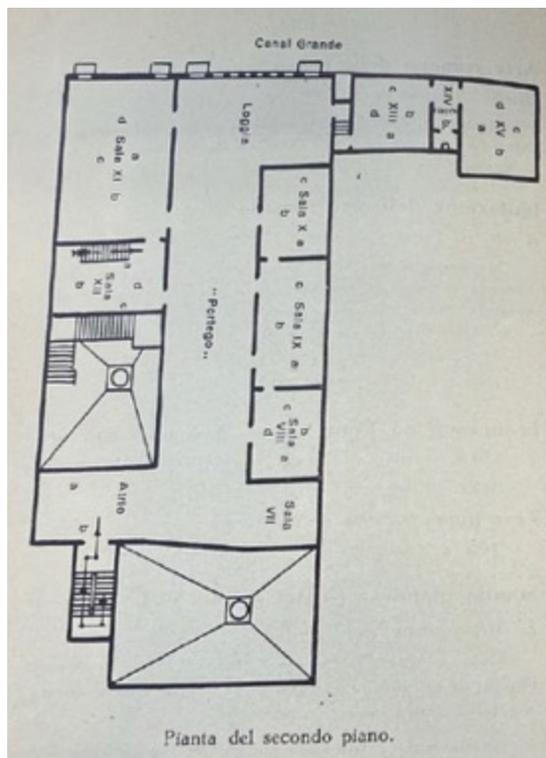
Pianta del secondo piano dopo il restauro di Giorgio Franchetti.
